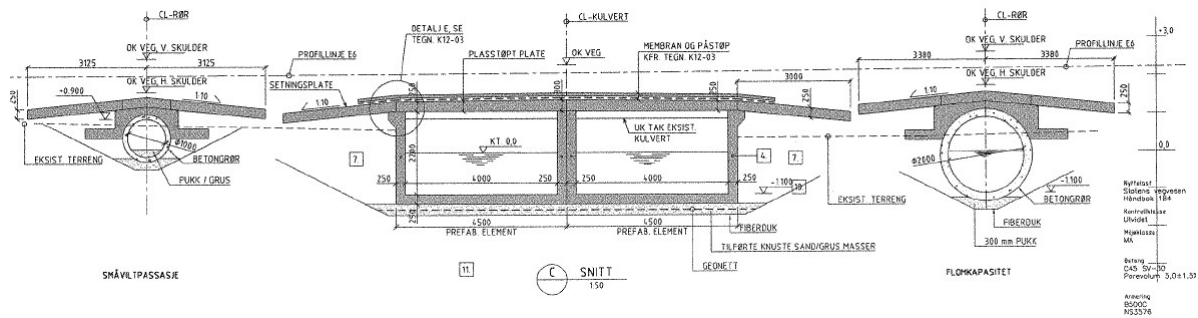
Planlagt utvidelse av eksisterende kulvertløsning. Det minste røret til venstre er den planlagte faunapassasjen og det større røret til høyre for kulvertene er et planlagt flomløp. Statens vegvesen / Aas-Jakobsen Tegn.nr. K12-01
